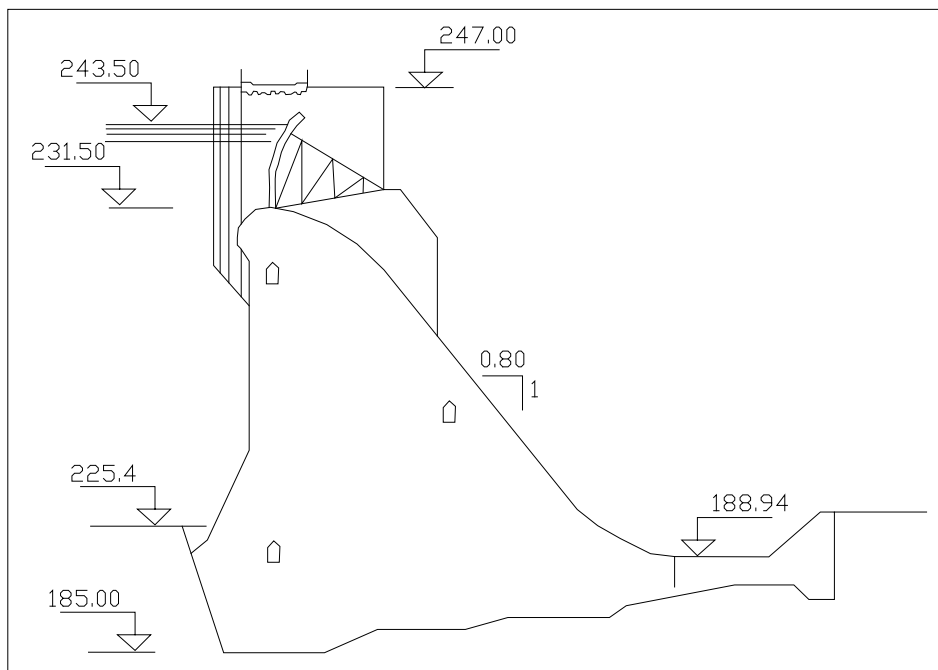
Sección transversal de la estructura de la presa Torrejón Tajo. Escala 1:1000.
